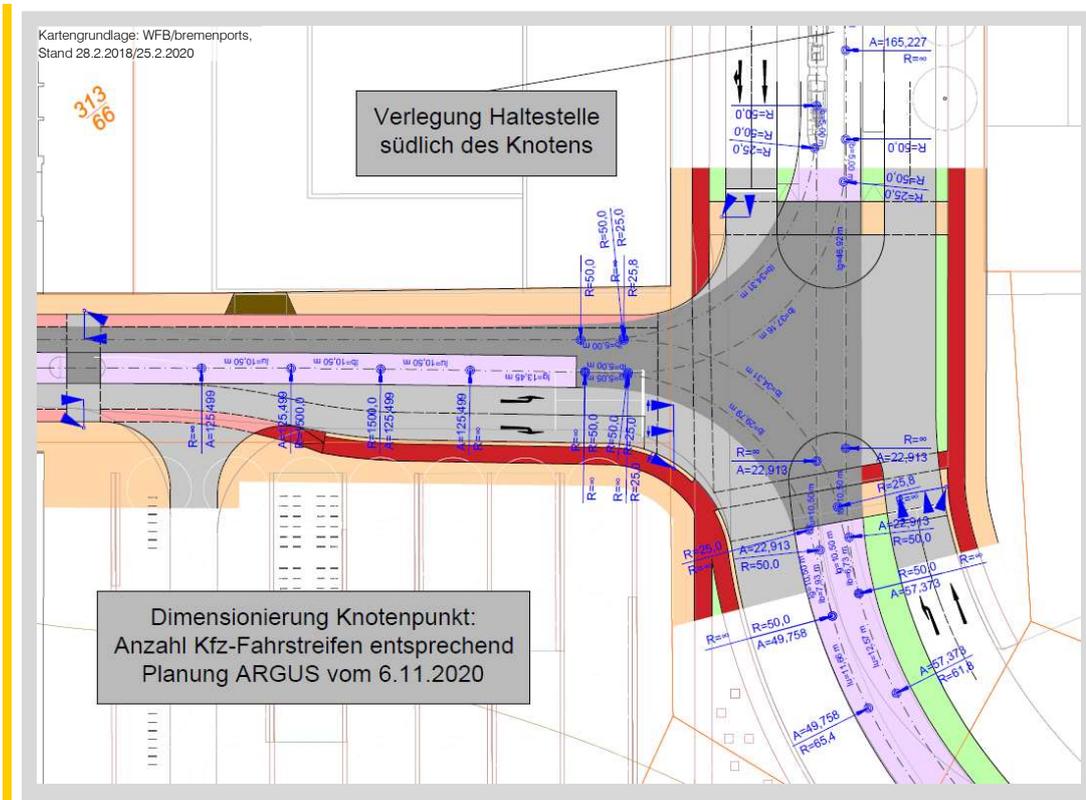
Ausschnitt Lageplan Knoten Hoerneckestraße/ Auf der Muggenburg
